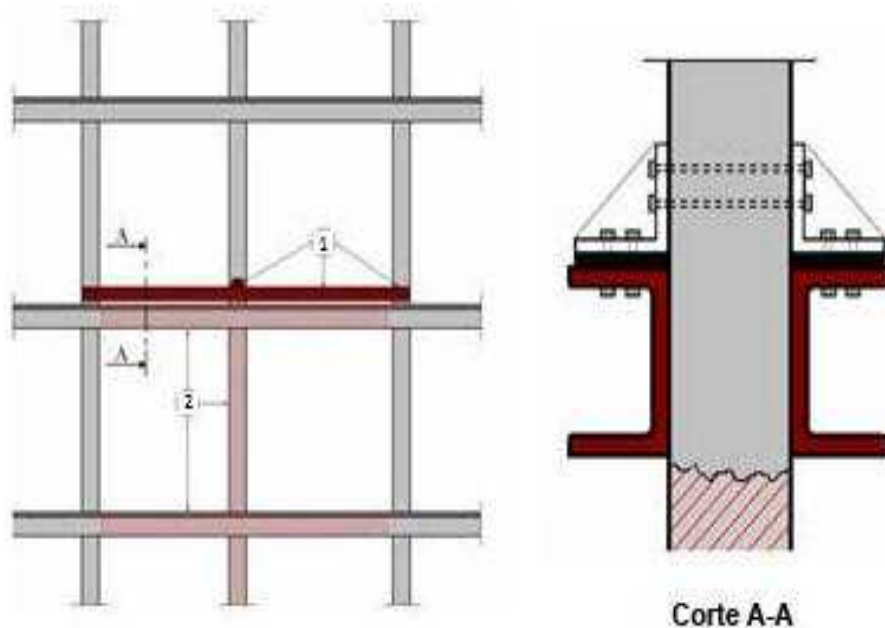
Supresión de un pilar mediante el refuerzo de la viga superior. 1) Colocación de perfiles metálicos, durmientes y puntos de apoyo. 2) Demolición de la zona considerada.³⁹
